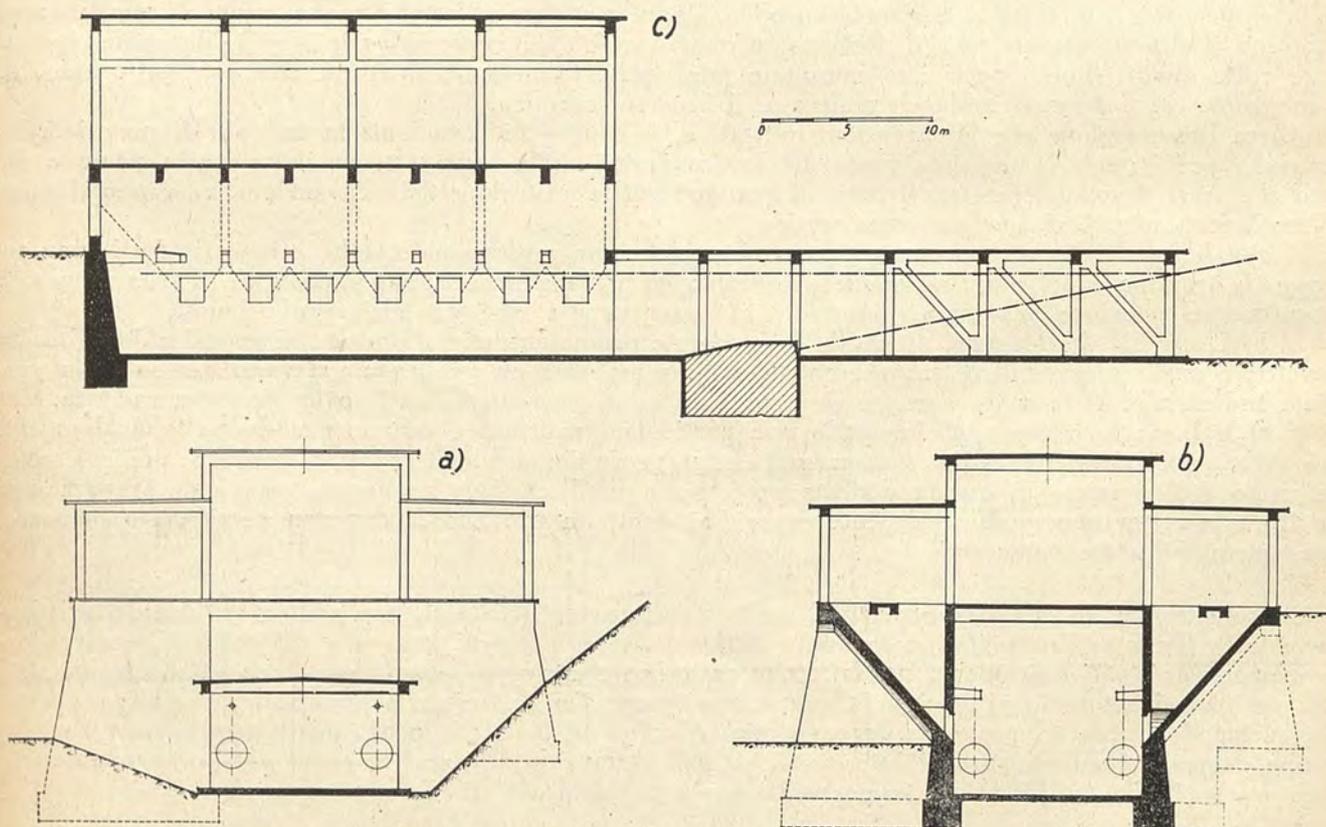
a) Prospetto — b) Sezione trasversale — c) Sezione longitudinale.
